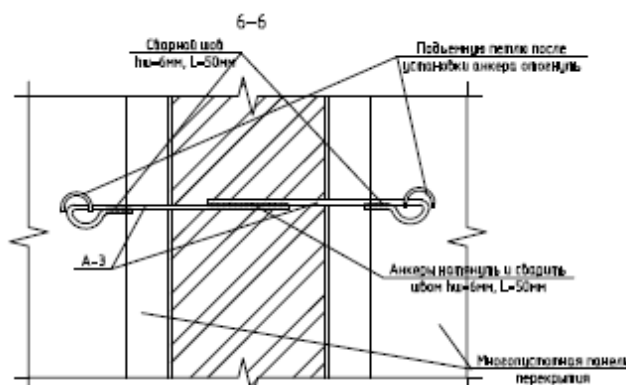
Узел анкеровки плит перекрытия. Обследование межэтажного перекрытия
